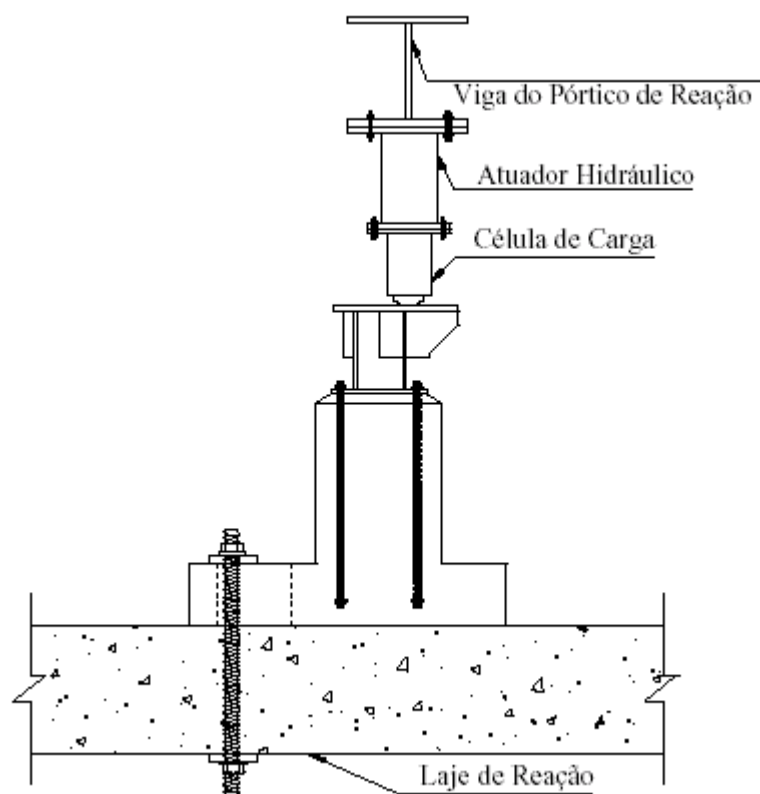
Detalhe da montagem do sistema de aplicação de carga e fixação do bloco de apoio utilizado nos Ensaios 1 a 5.
